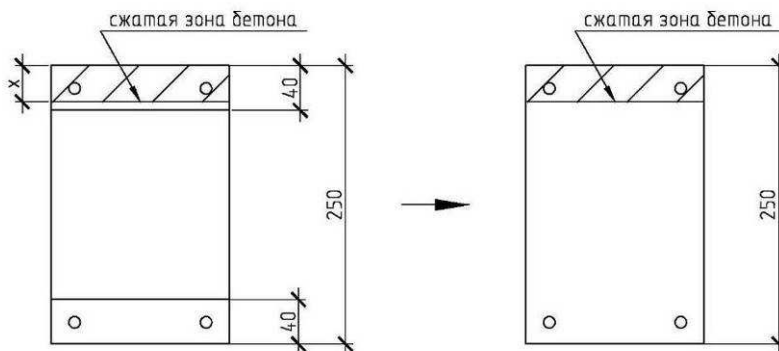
Схема перехода к расчетному сечению, когда в сжатую зону попадает один слой.
